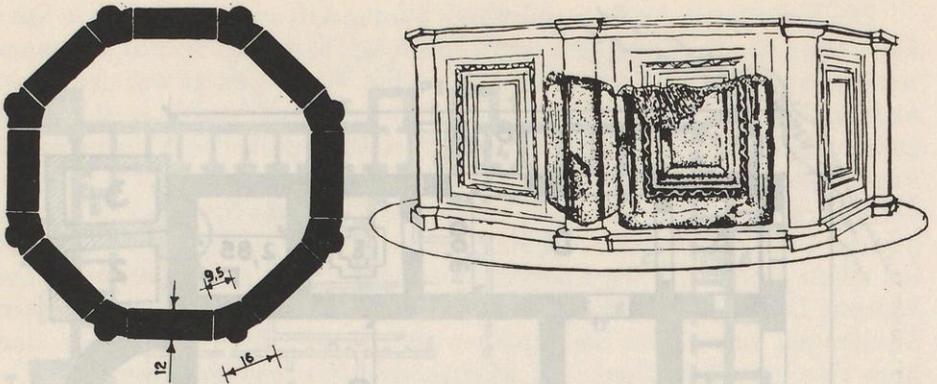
Taufanlage. Grundriß und Rekonstruktion
